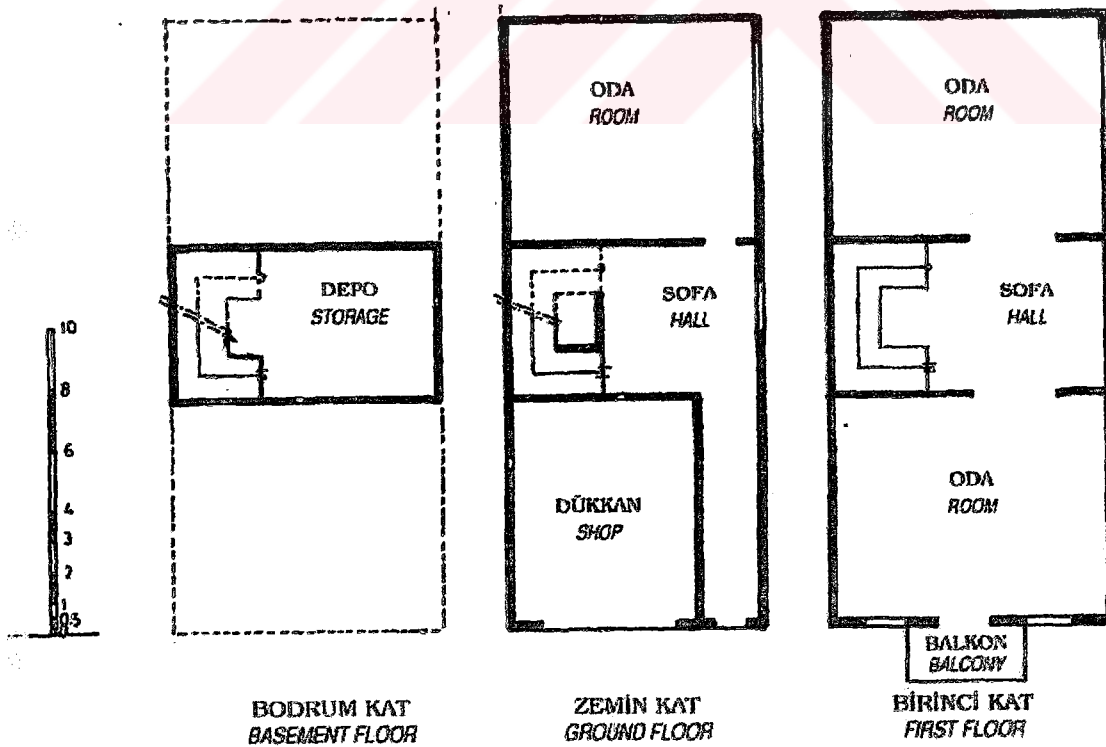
Çanakkale yolu planlarından bir örnek (Çeyap, 1997)
